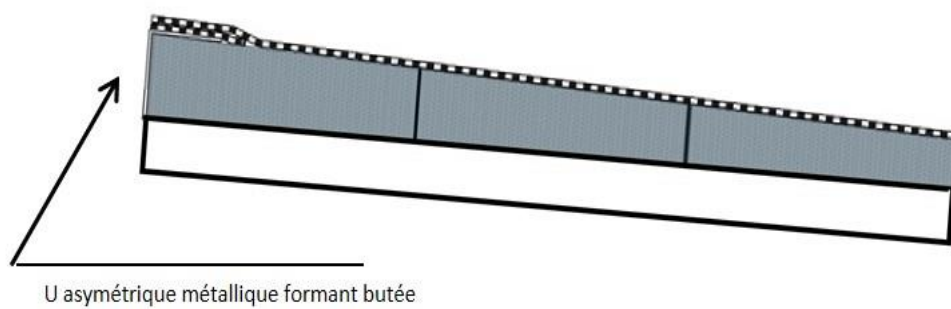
Coupe de principe sur rive sans acrotère, sur élément porteur métallique¹
